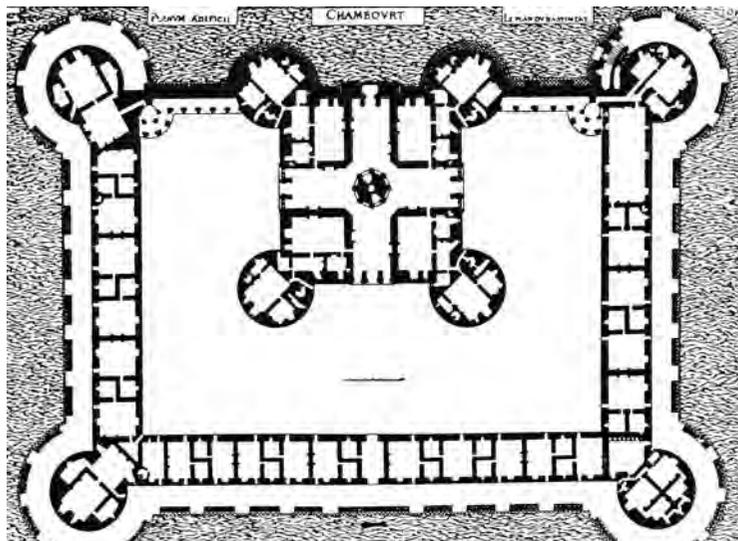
Schloss Chambord, Grundriss der Schlossanlage
